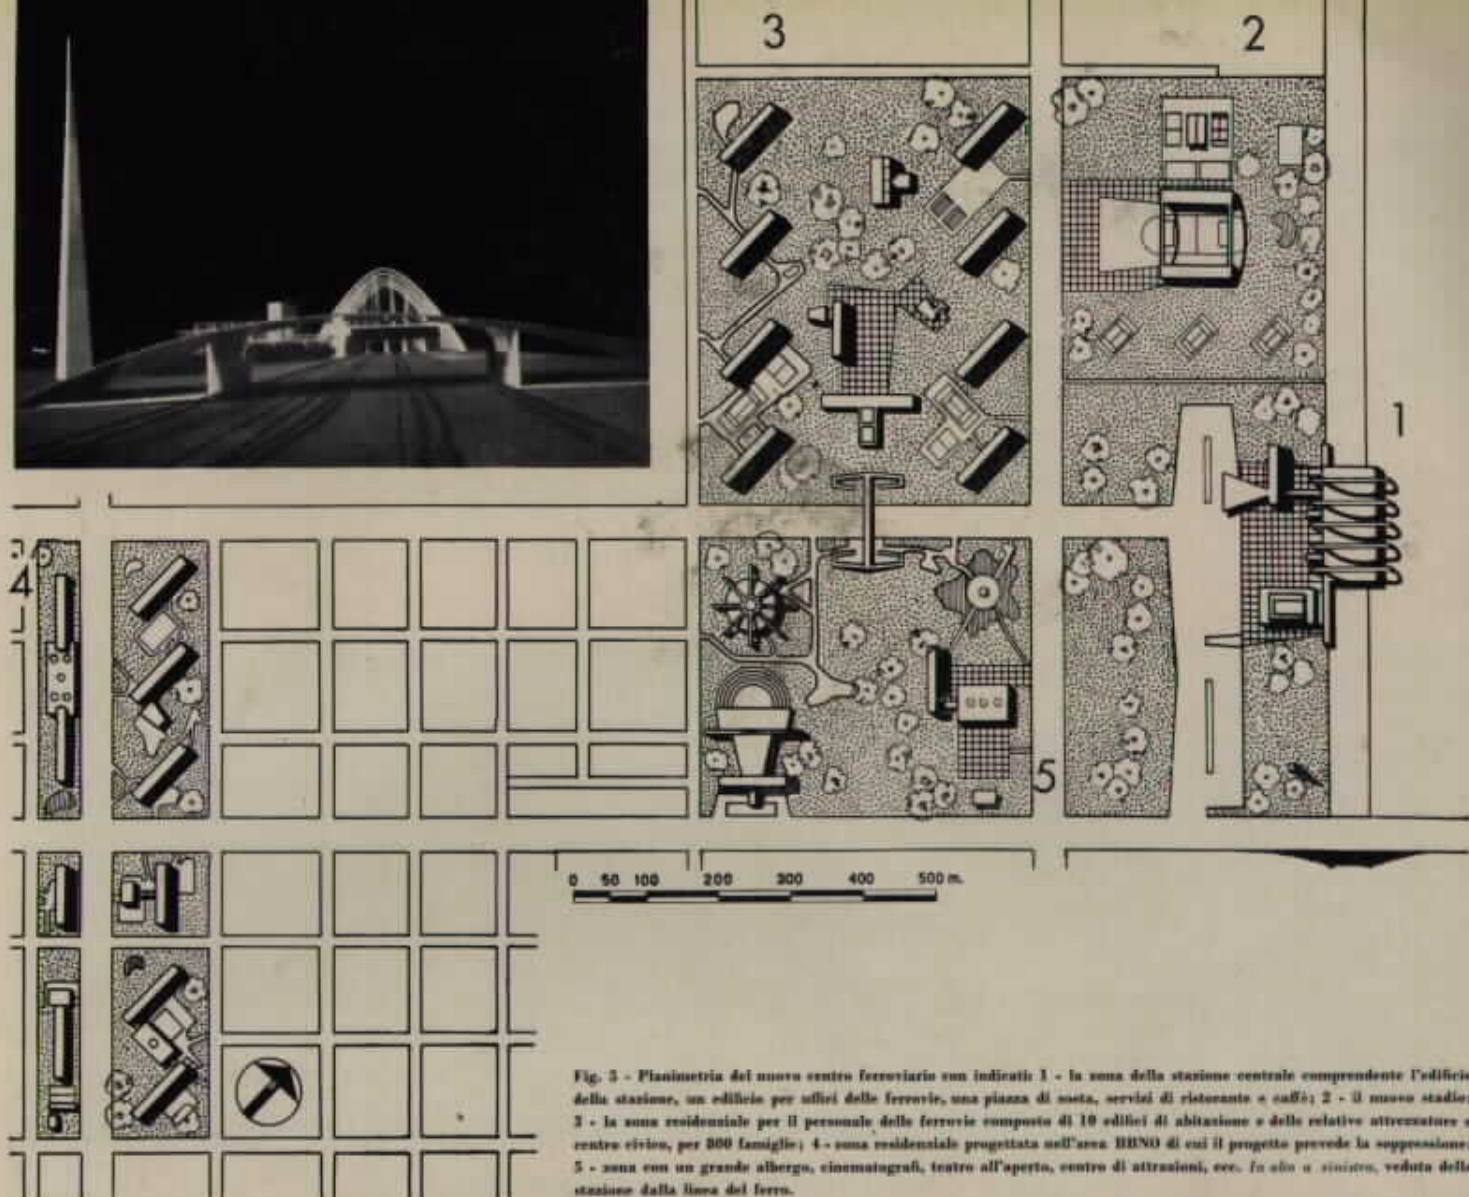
Pianimetria del nuovo centro ferroviario con indicati: 1 - la zona della stazione centrale comprendente l'edificio della stazione, un edificio per uffici delle ferrovie, una piazza di sosta, servizi di ristorante e caffè; 2 - il nuovo stadio; 3 - la zona residenziale per il personale delle ferrovie composta di 10 edifici di abitazione e delle relative attrezzature e centro civico, per 800 famiglie; 4 - zona residenziale progettata nell'area BBNO di cui il progetto prevede la soppressione; 5 - zona con un grande albergo, cinematografo, teatro all'aperto, centro di attrazioni, ecc. In alto a sinistra, veduta della stazione dalla linea del ferro.
